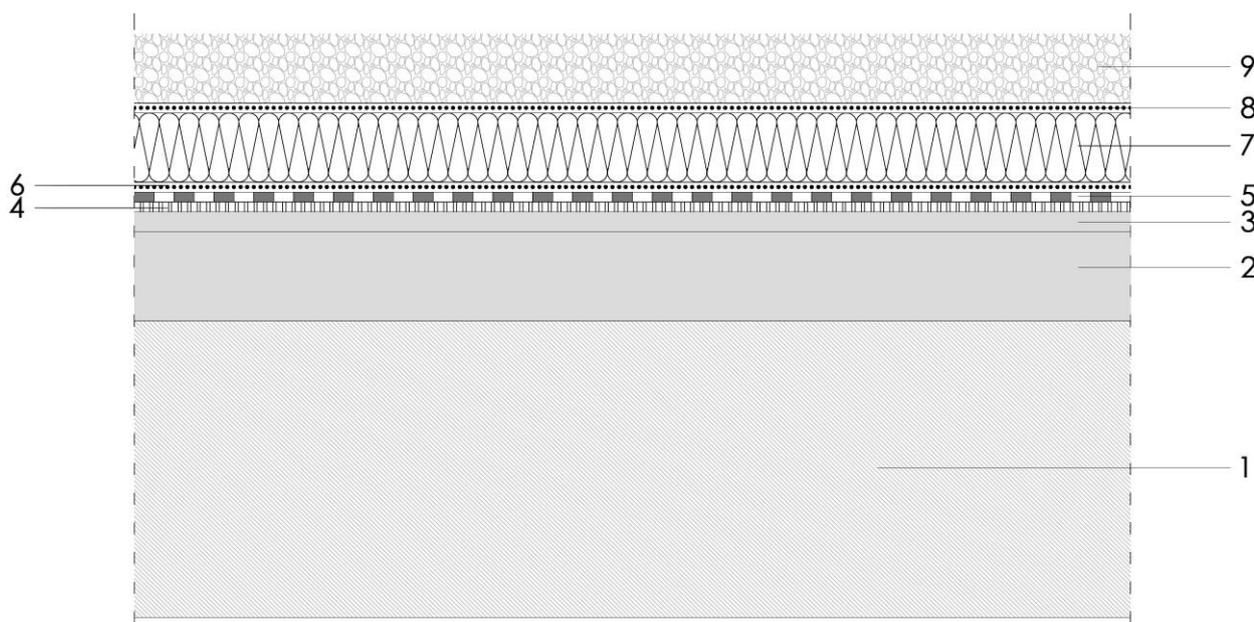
Detalle constructivo de cubierta invertida con protección de grava.
